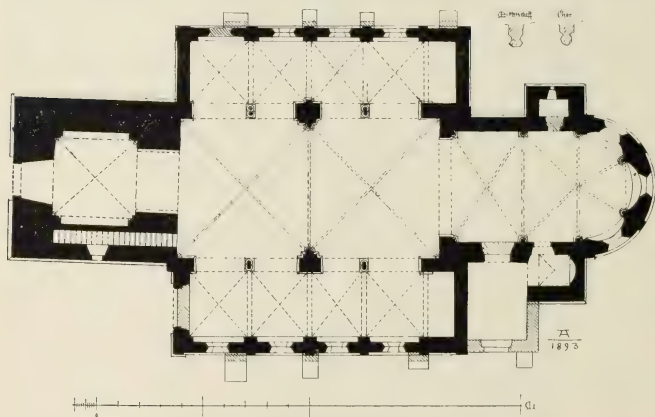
Rheinkassel. Grundriss der Pfarrkirche.
